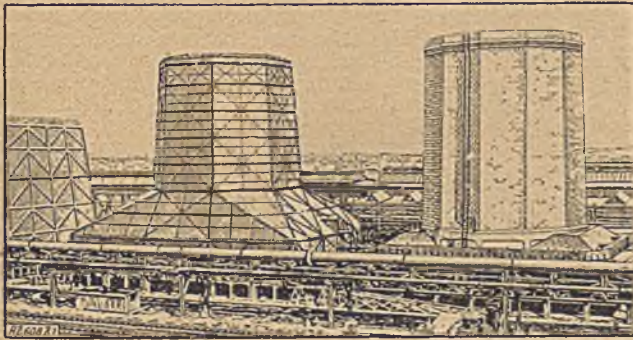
Kühlturm aus Eisenbeton neben Kühltürmen in Holz- und Eisenkonstruktion.
